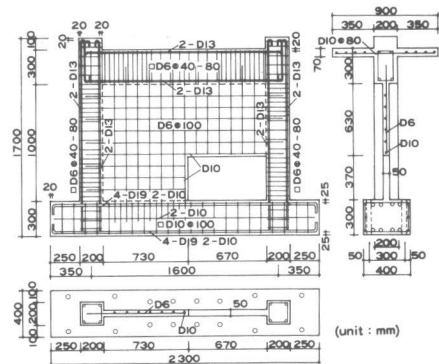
試験体FW5-0.367-S-MBの形状および配筋 (単位: mm)
